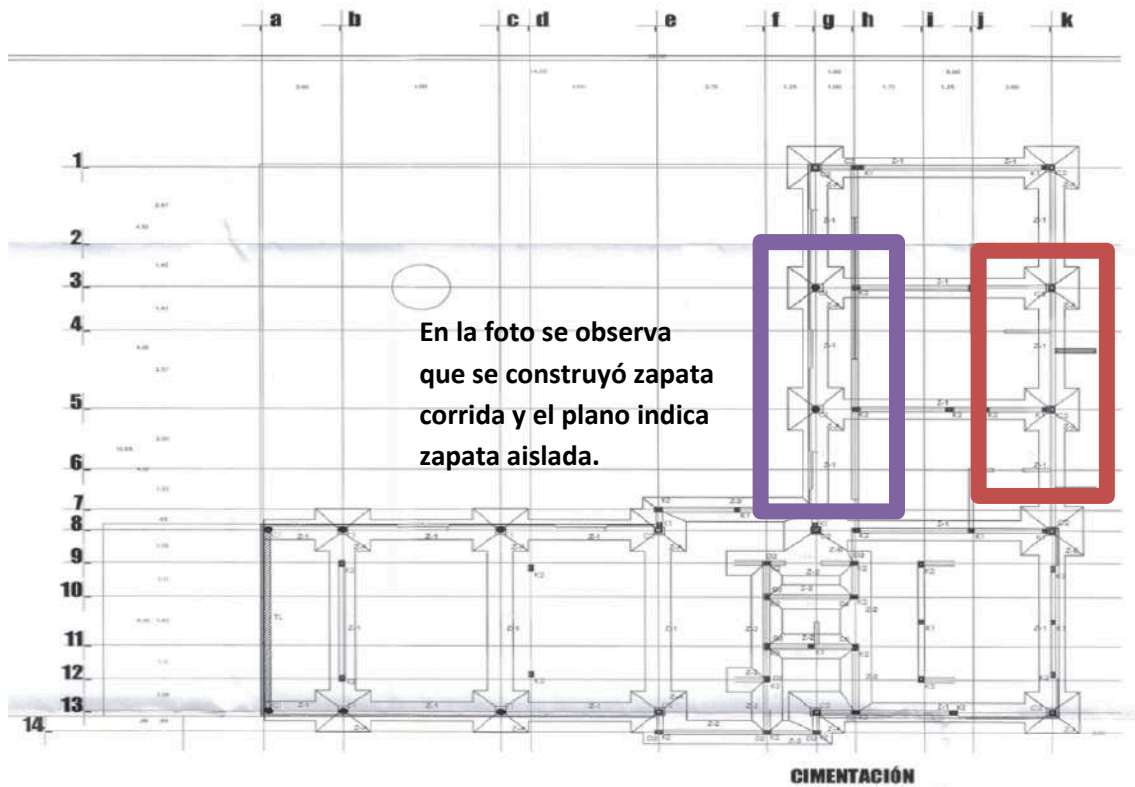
Planta de cimentación ejecutada en obra contra planta de cimentación propuesta.
